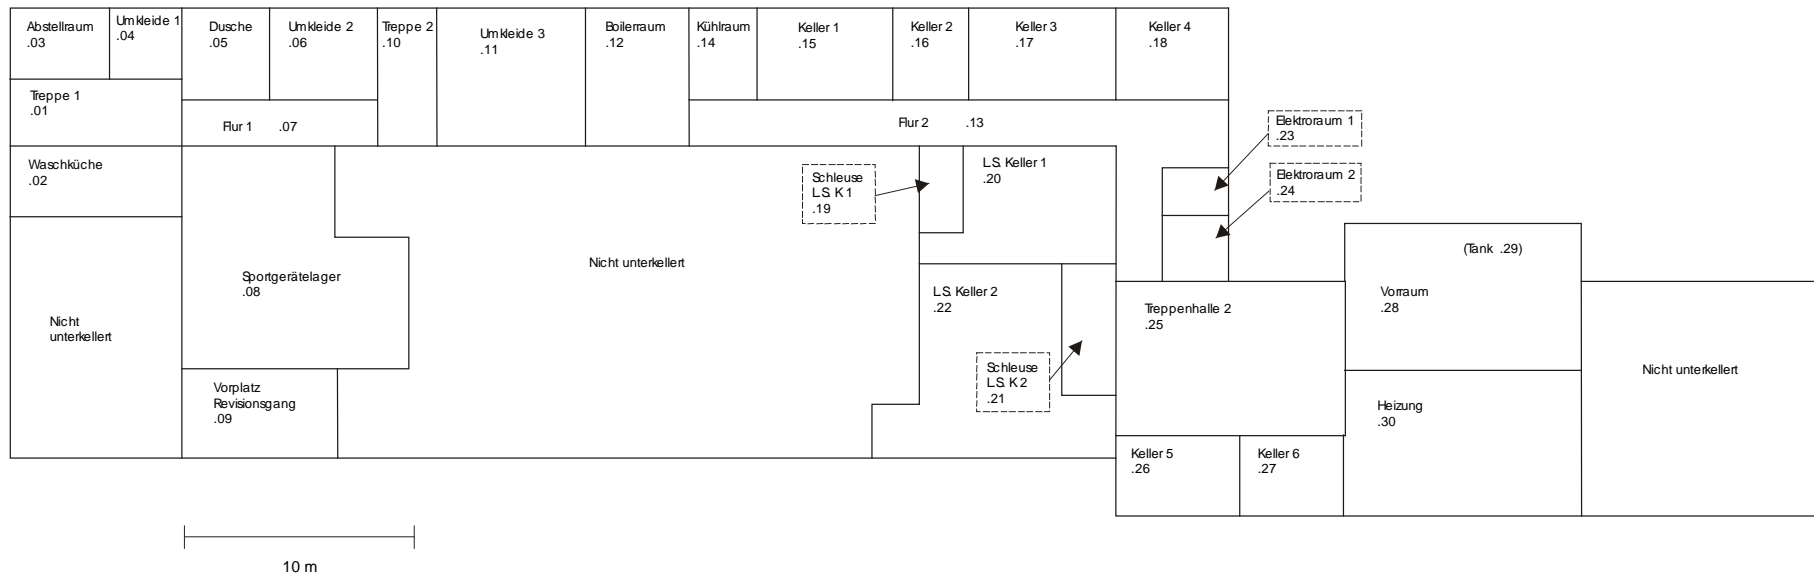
Bauteil 1- Räume Untergeschoß mit DDC-Nummerierung
